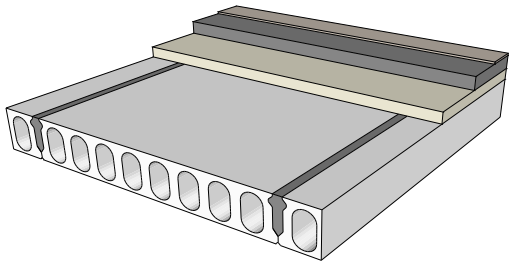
Konstruktionsschema Spannbeton-Hohldecke
